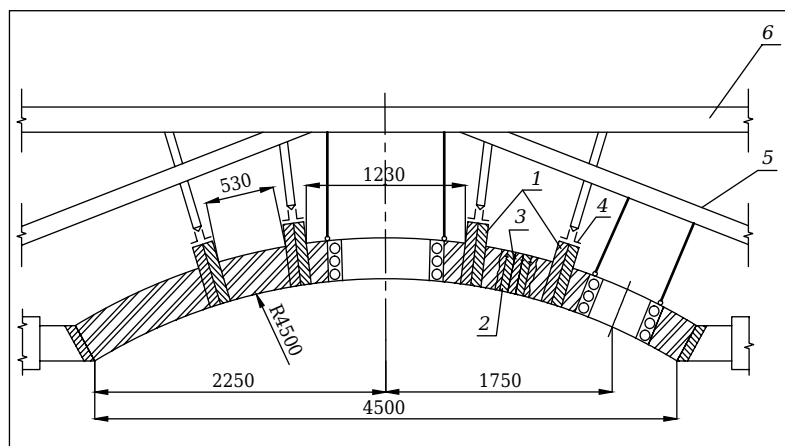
Схема футеровки распорно-подвесного свода кивцэтного агрегата: 1 — ряд сдвоенных изделий длиной 460 мм для крепления подвесок; 2 — огнеупорные периклазохромитовые изделия длиной 300 мм; 3 — металлический палец; 4 — подвеска; 5 — укосина; 6 — поперечная балка
